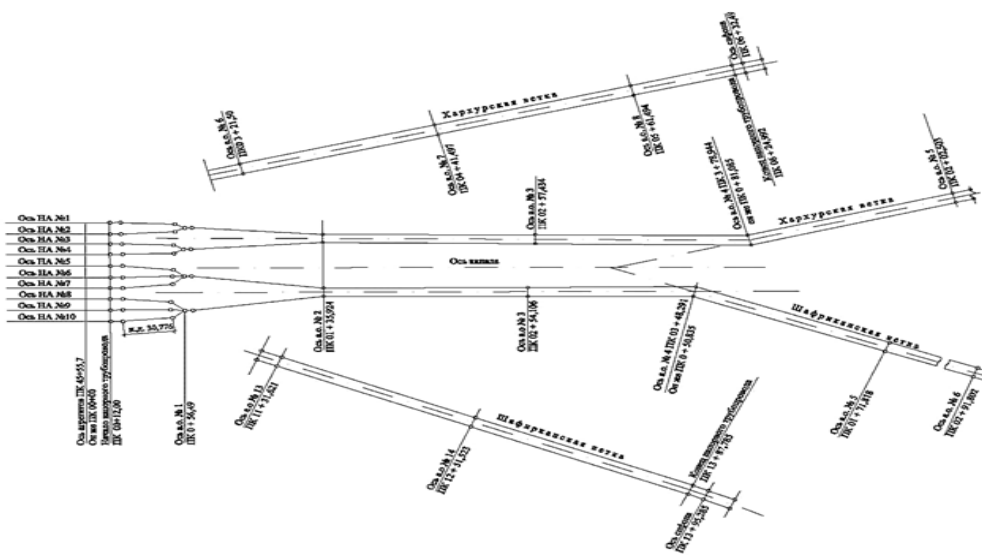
План-схема напорных трубопроводов насосной станции «Кизилтепа»
